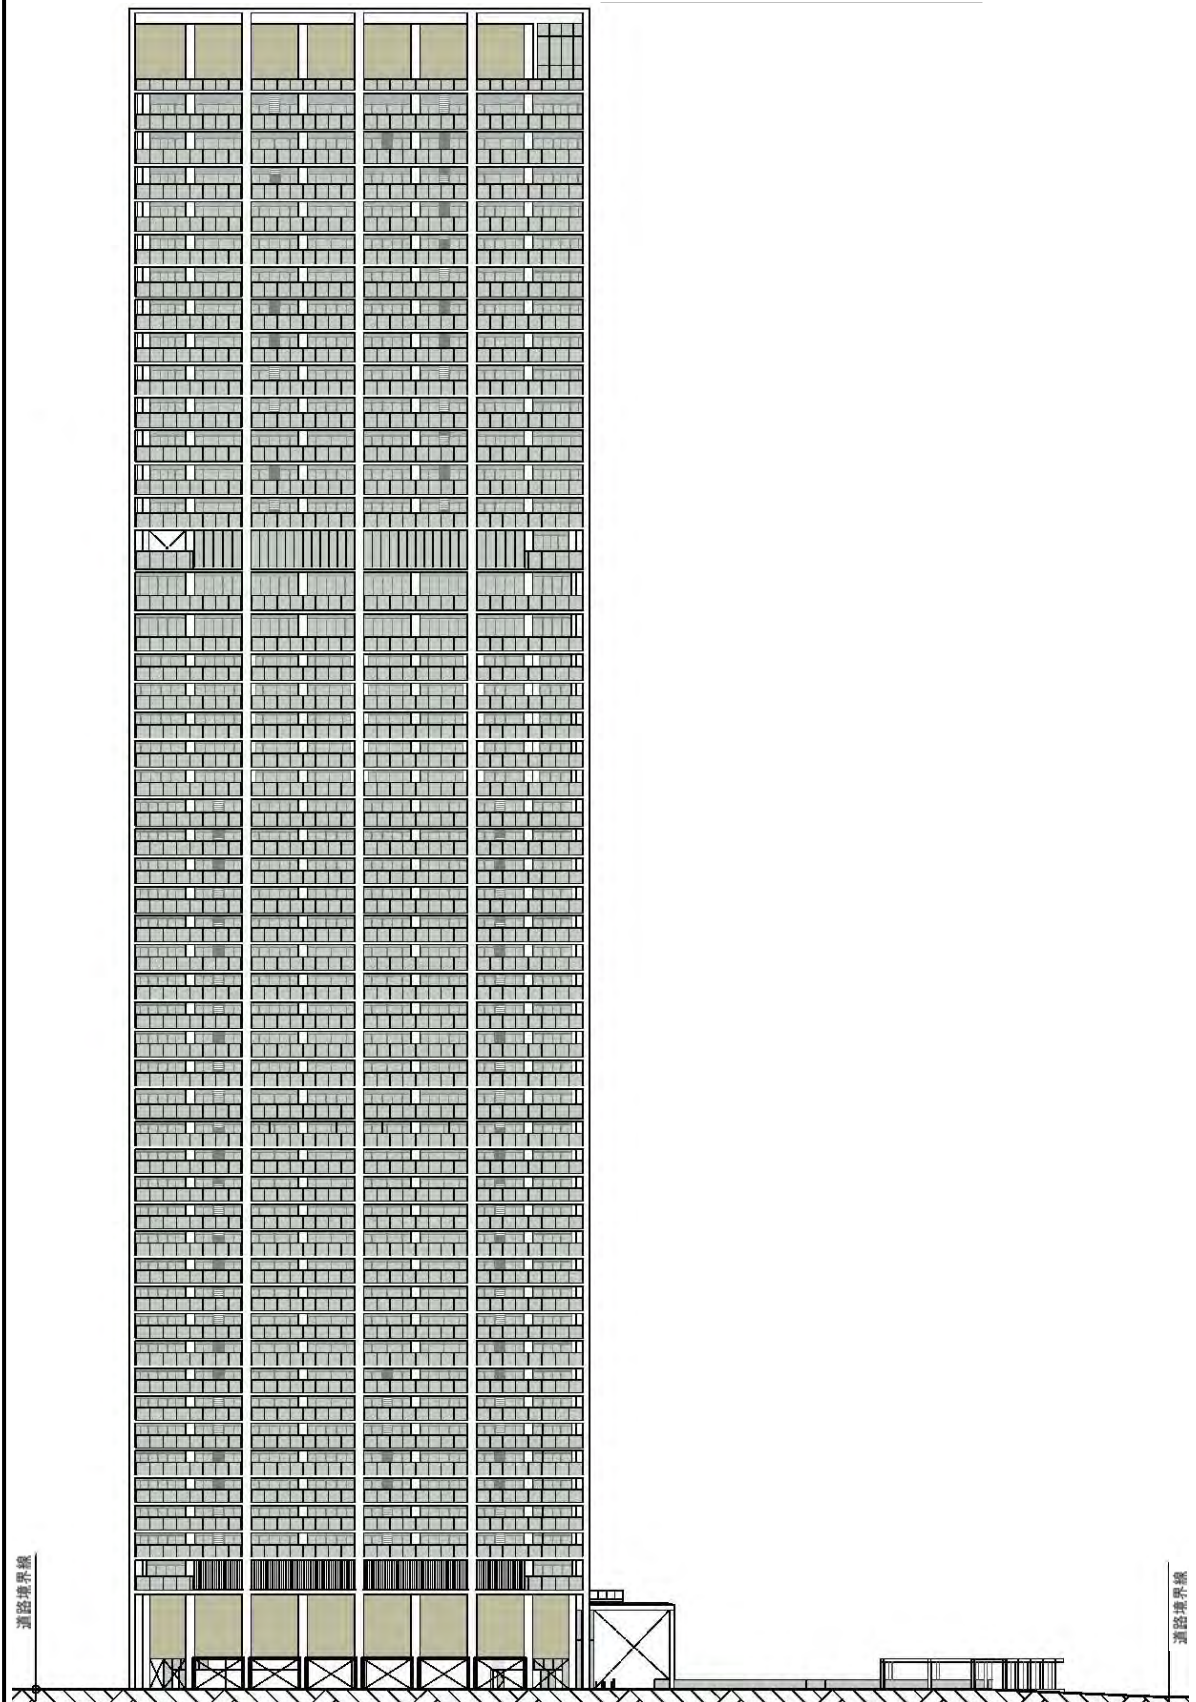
(8) 立面図 (西立面図 S=1:1,000) 【変更後】
